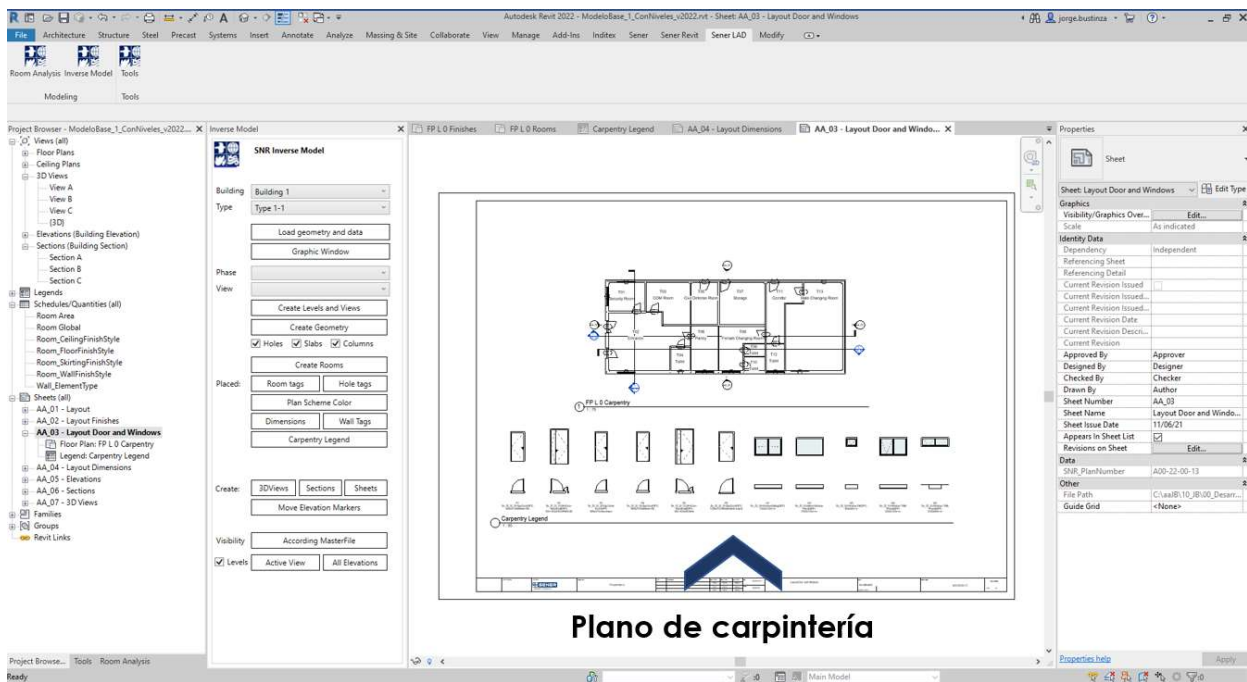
Plano de carpinterías. Fuente: Propio(2021)
